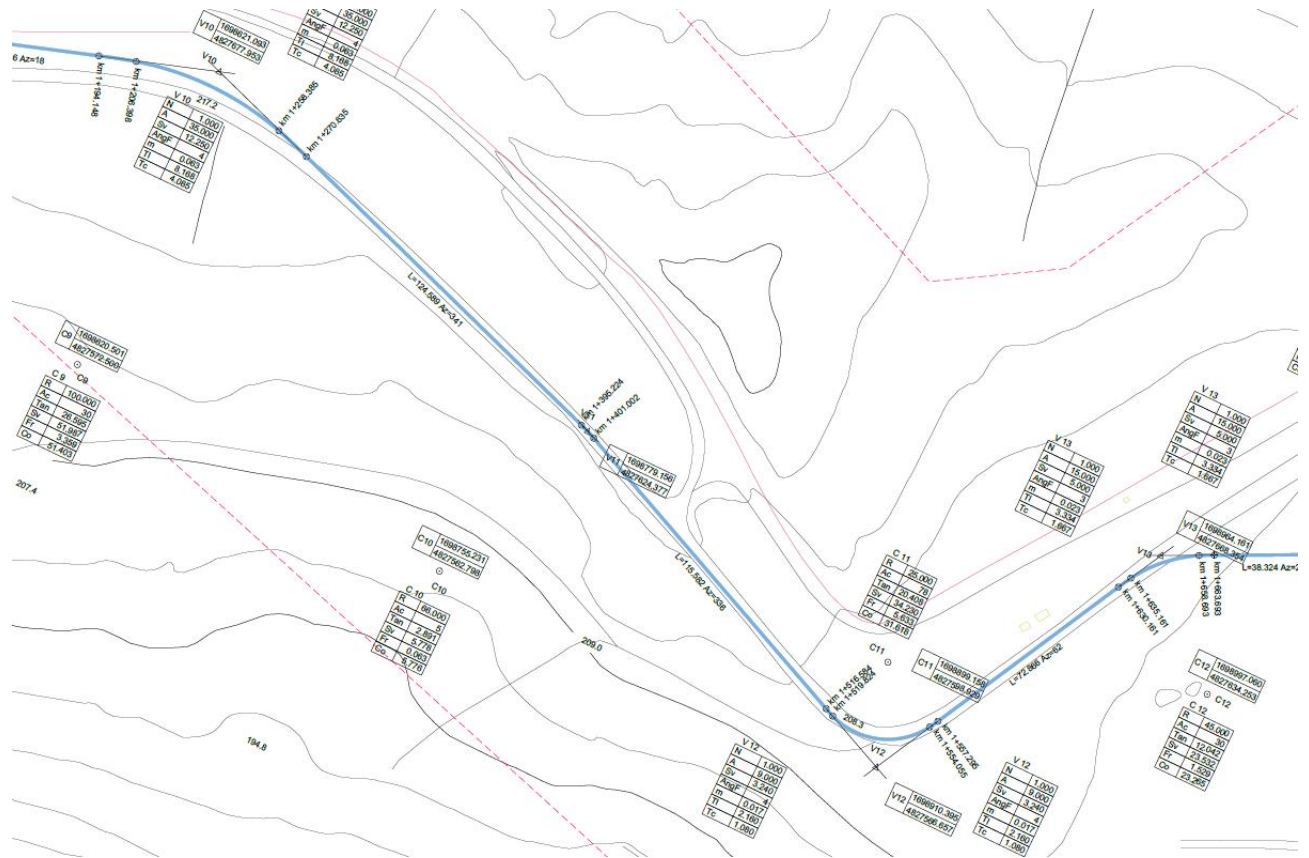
Stralcio Planimetria di Tracciamento Ramo Nord-Est
